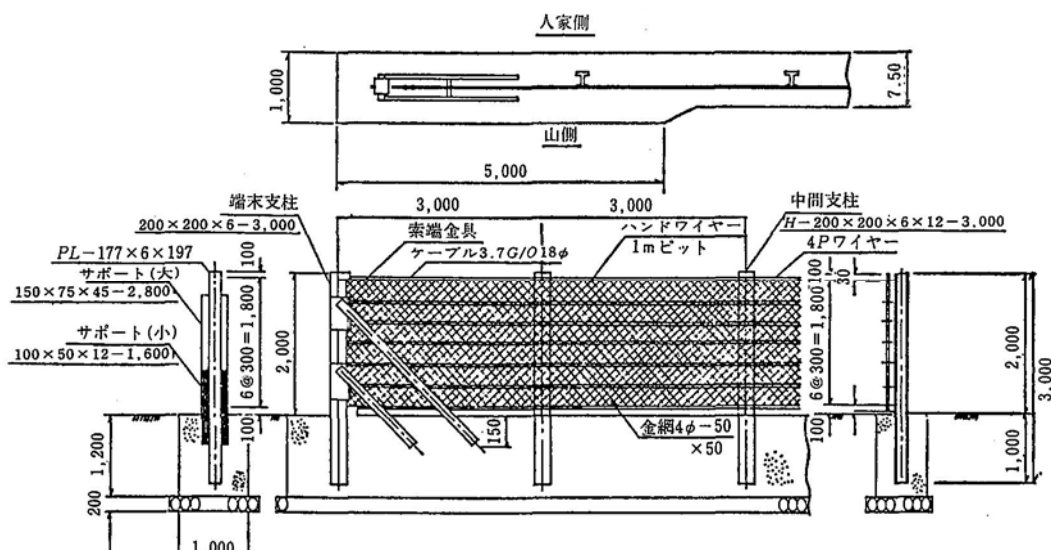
ワイヤロープ金網式落石防護柵工の標準的タイプ図の一例（単位：mm）（新斜面崩壊 p283）
